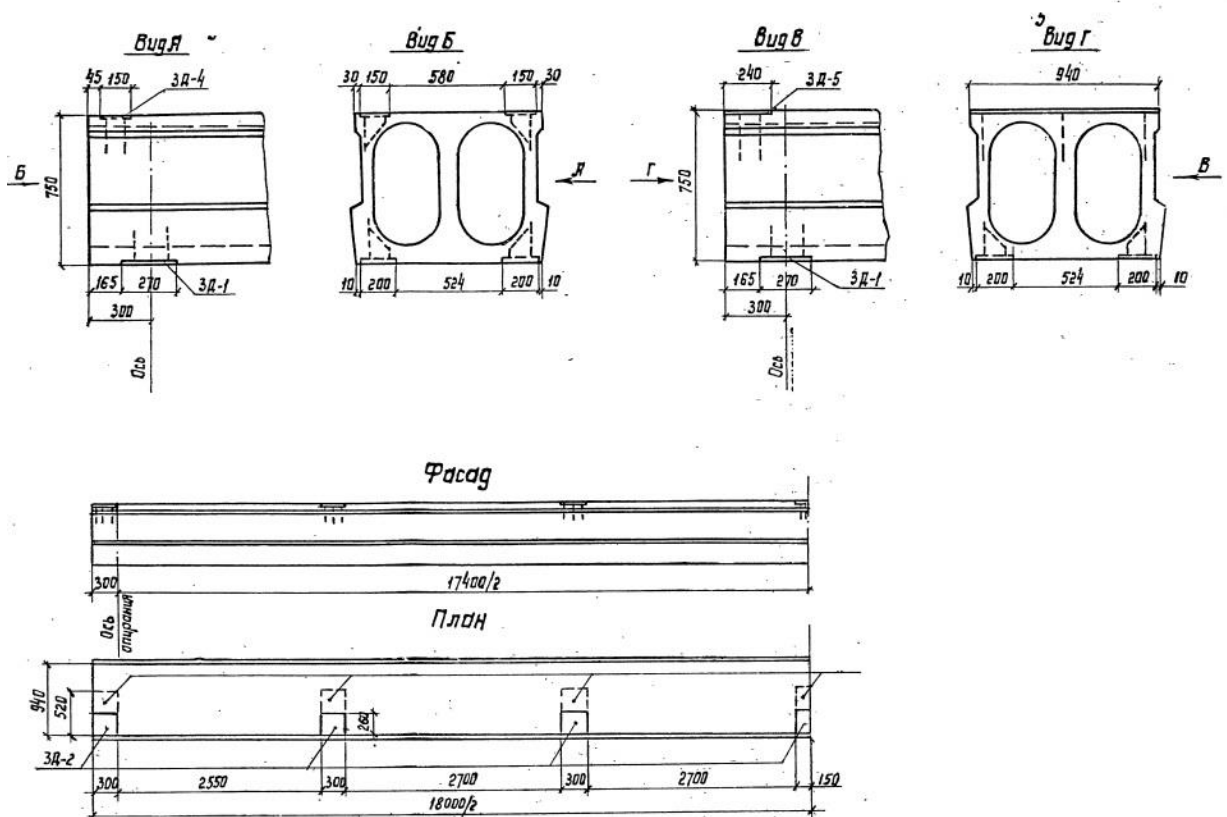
Плита мостового перекриття П 18-10 [4]
